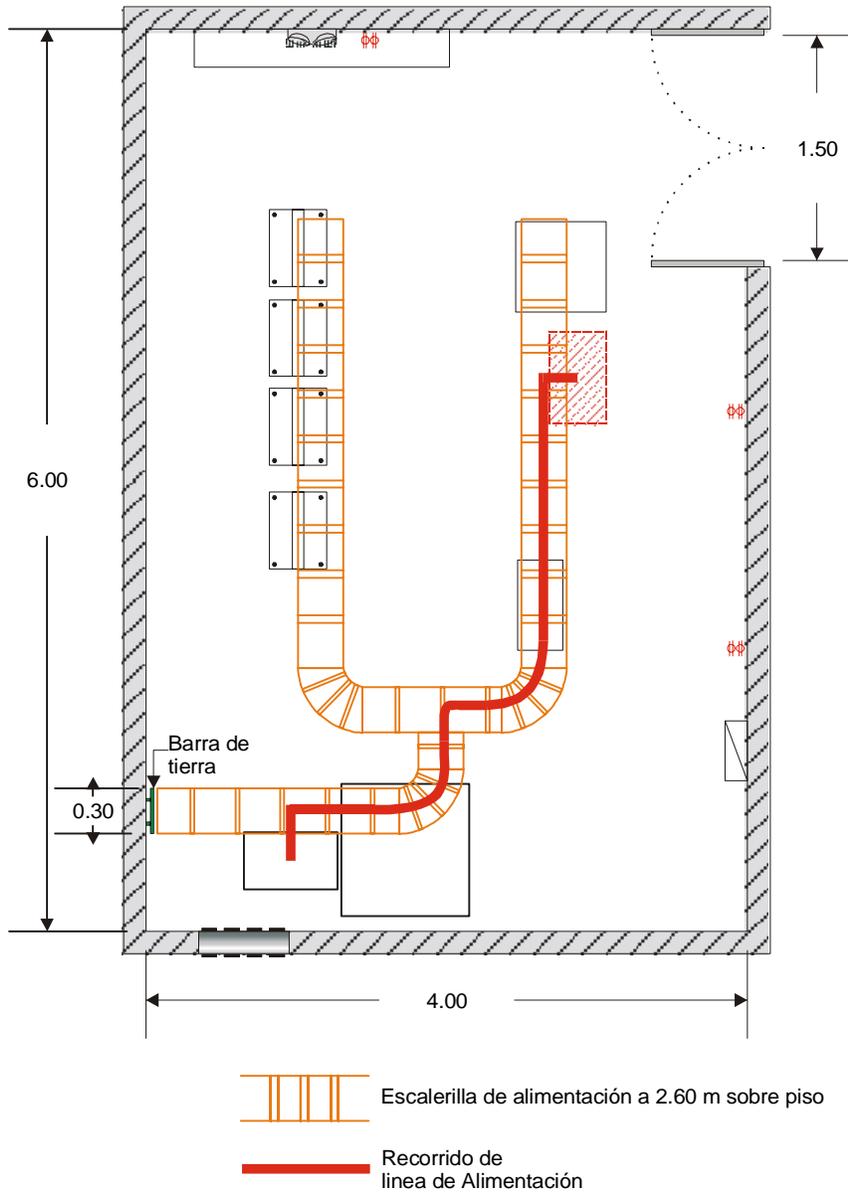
Escalerilla de alimentación miniPOP Santa Fe.
